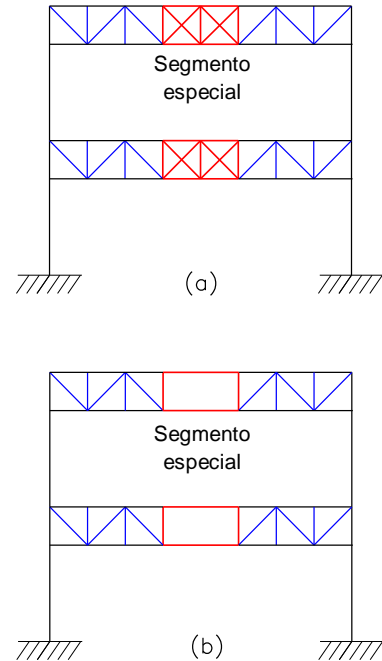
Pórtico no arriostrado con vigas reticuladas, (a) segmento especial con reticulado en X, y (b) segmento con panel Vierendeel.
